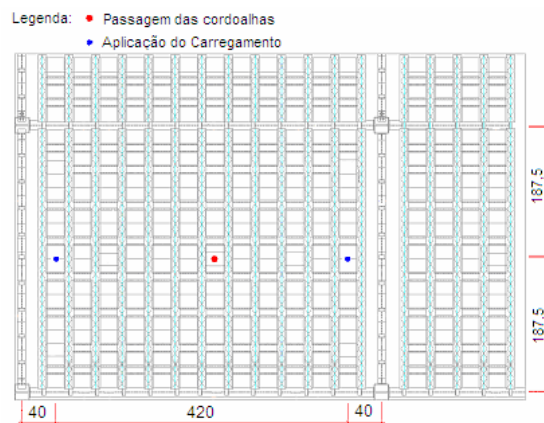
Pontos de passagem da cordoalha pela laje e pontos de aplicação do carregamento concentrado na direção do centro das vigas secundárias.
